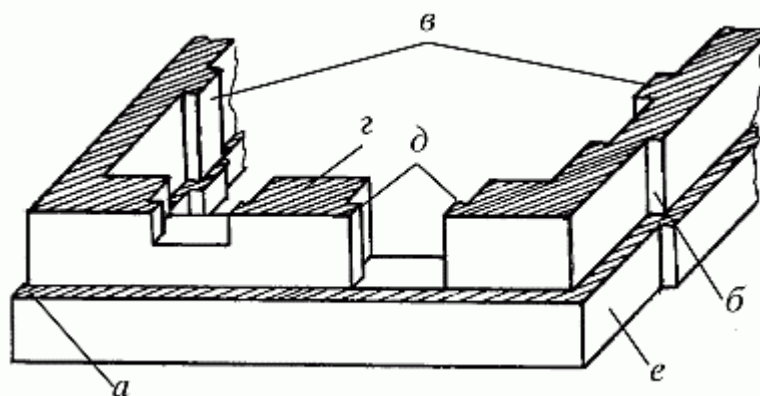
Детали каменных конструкций: а – обрез; б – уступ кладки; в – пилястры; г – простенок; д – четверть; е – цоколь
